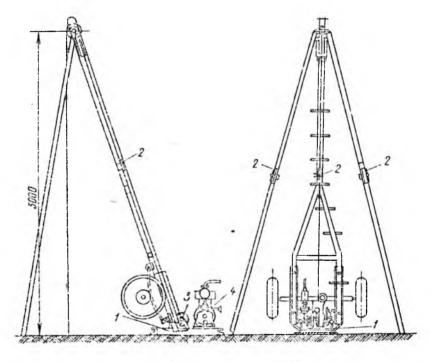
Общий вид установки БУКС 1 - рам : станка; 2 - трубчатая тренога; 3 - фрикционная лебедка; 4 - двигатель
